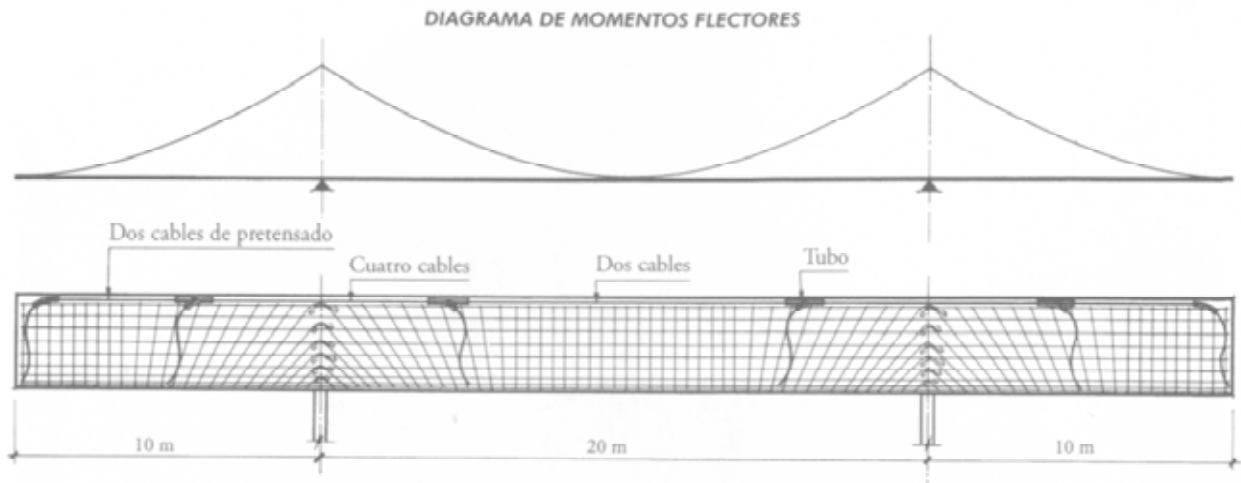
Acueducto de Alloz. Navarra 1940. Eduardo Torroja, ingeniero.
